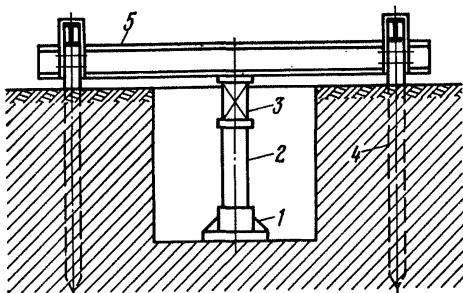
Схема установки для испытаний сжимаемости грунтов нагрузкой на штамп.
